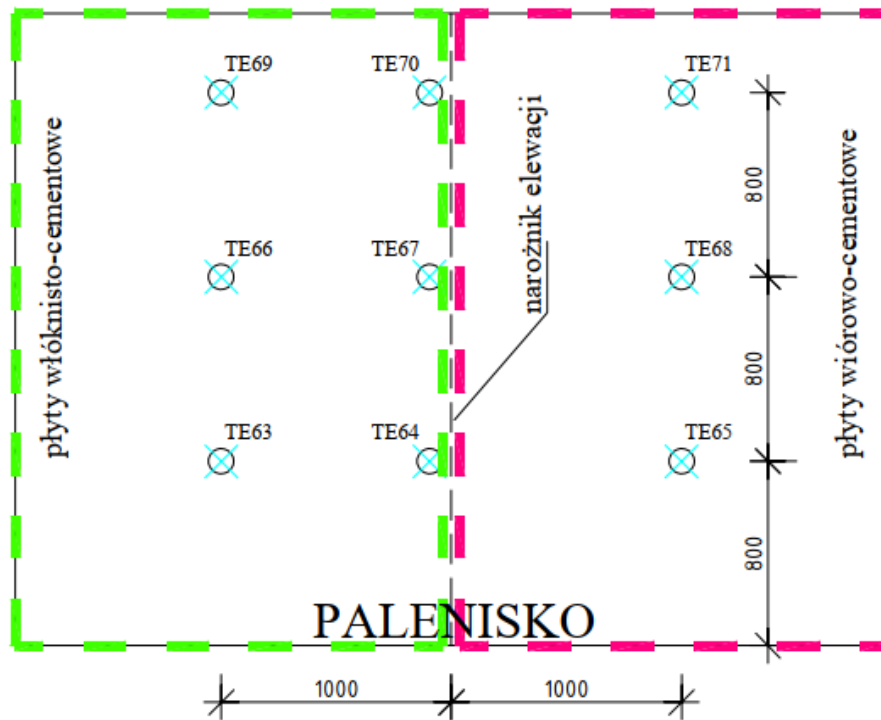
Elewacja wentylowana na budynku modelowym – seria badań G
